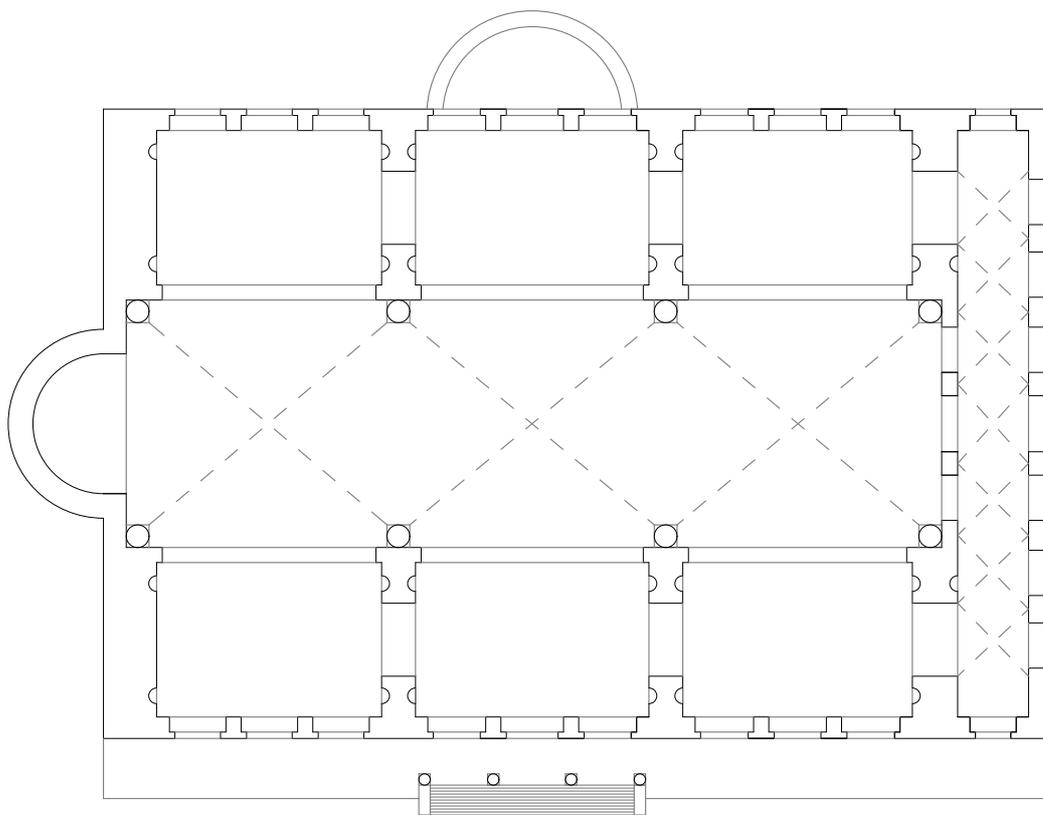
Planta da Basílica de Constantino/Maxêncio
